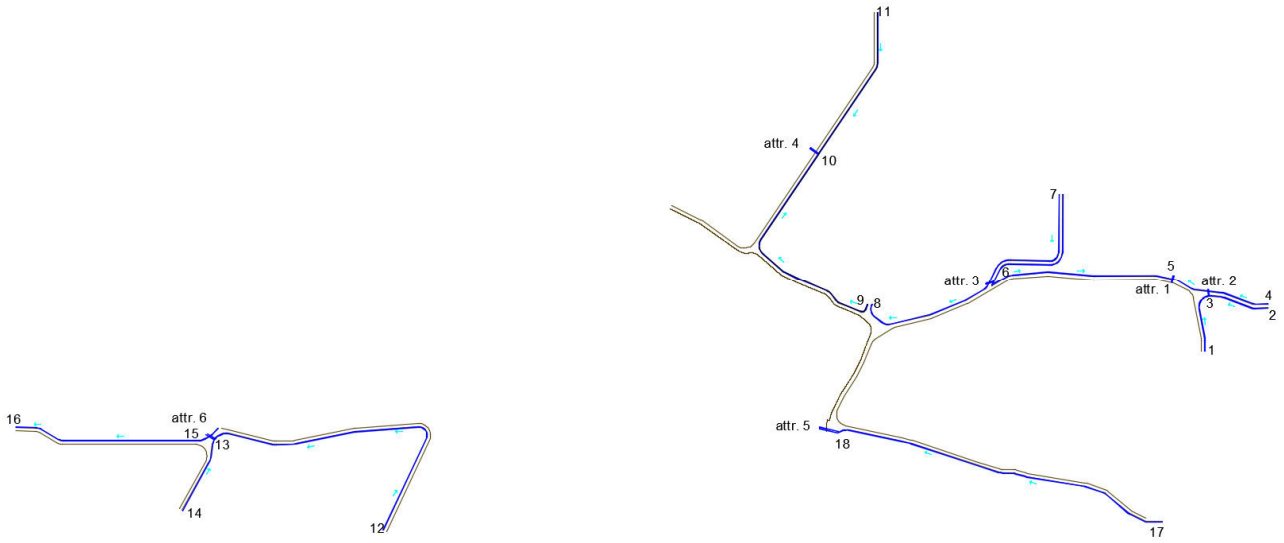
Planimetria delle cunette e attraversamenti viabilità
